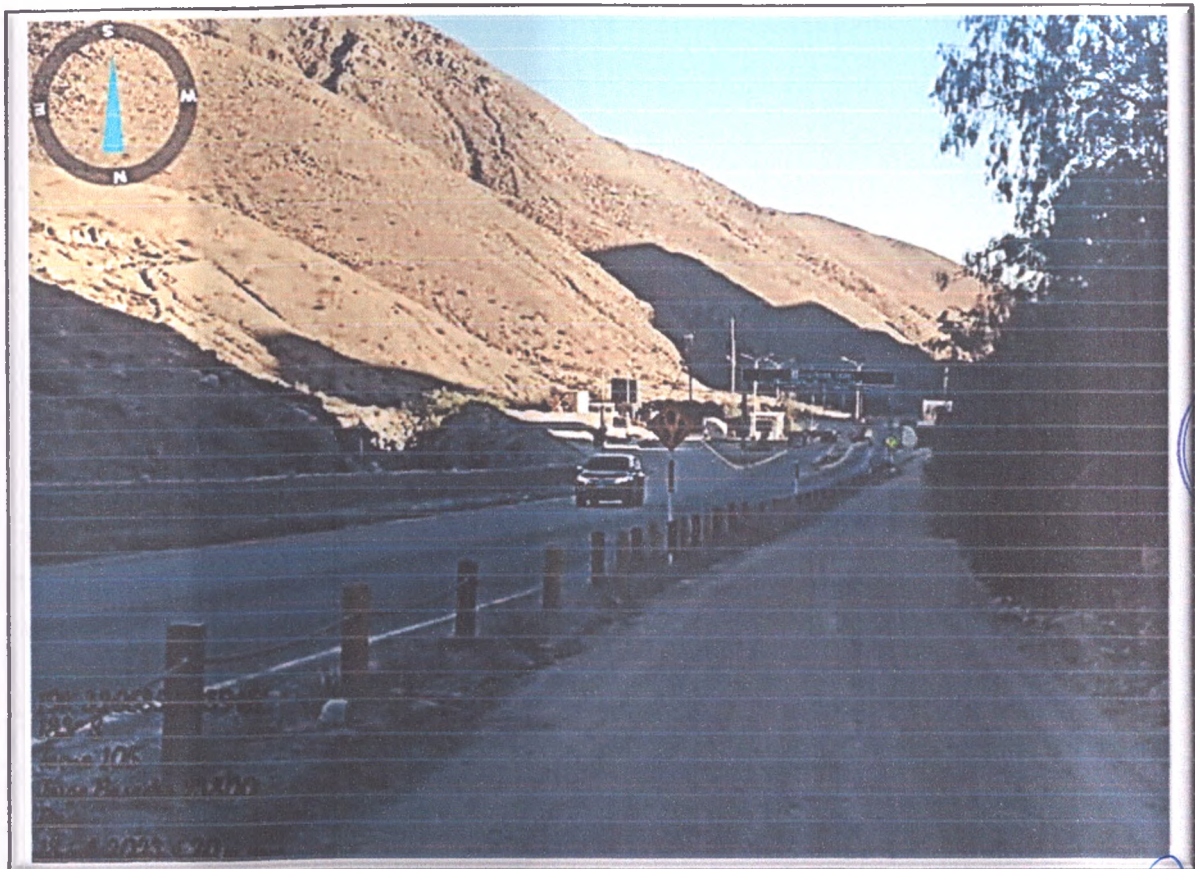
Plataforma de rodadura presenta ahuellamiento y desgaste por erosión, zona de plantas para roce, Km. 88+000
